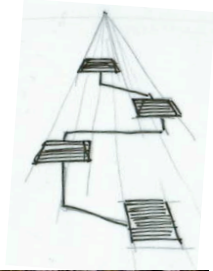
Termas Geométricas. Planta implantação. • (Archdaily, 2014)
